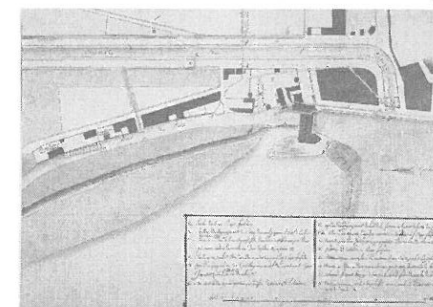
Pianta della creazione del canale *Saint-Pierre (de Brienne)* 1770-1776, che collega la navigazione tra *Garonne* e il *Canal du midi*, estratto dall'*Archives des Voies navigables de France*, pubblicato in ADGE, DELVIT, MARCONIS, MARFAING, VANNIER 2009.
